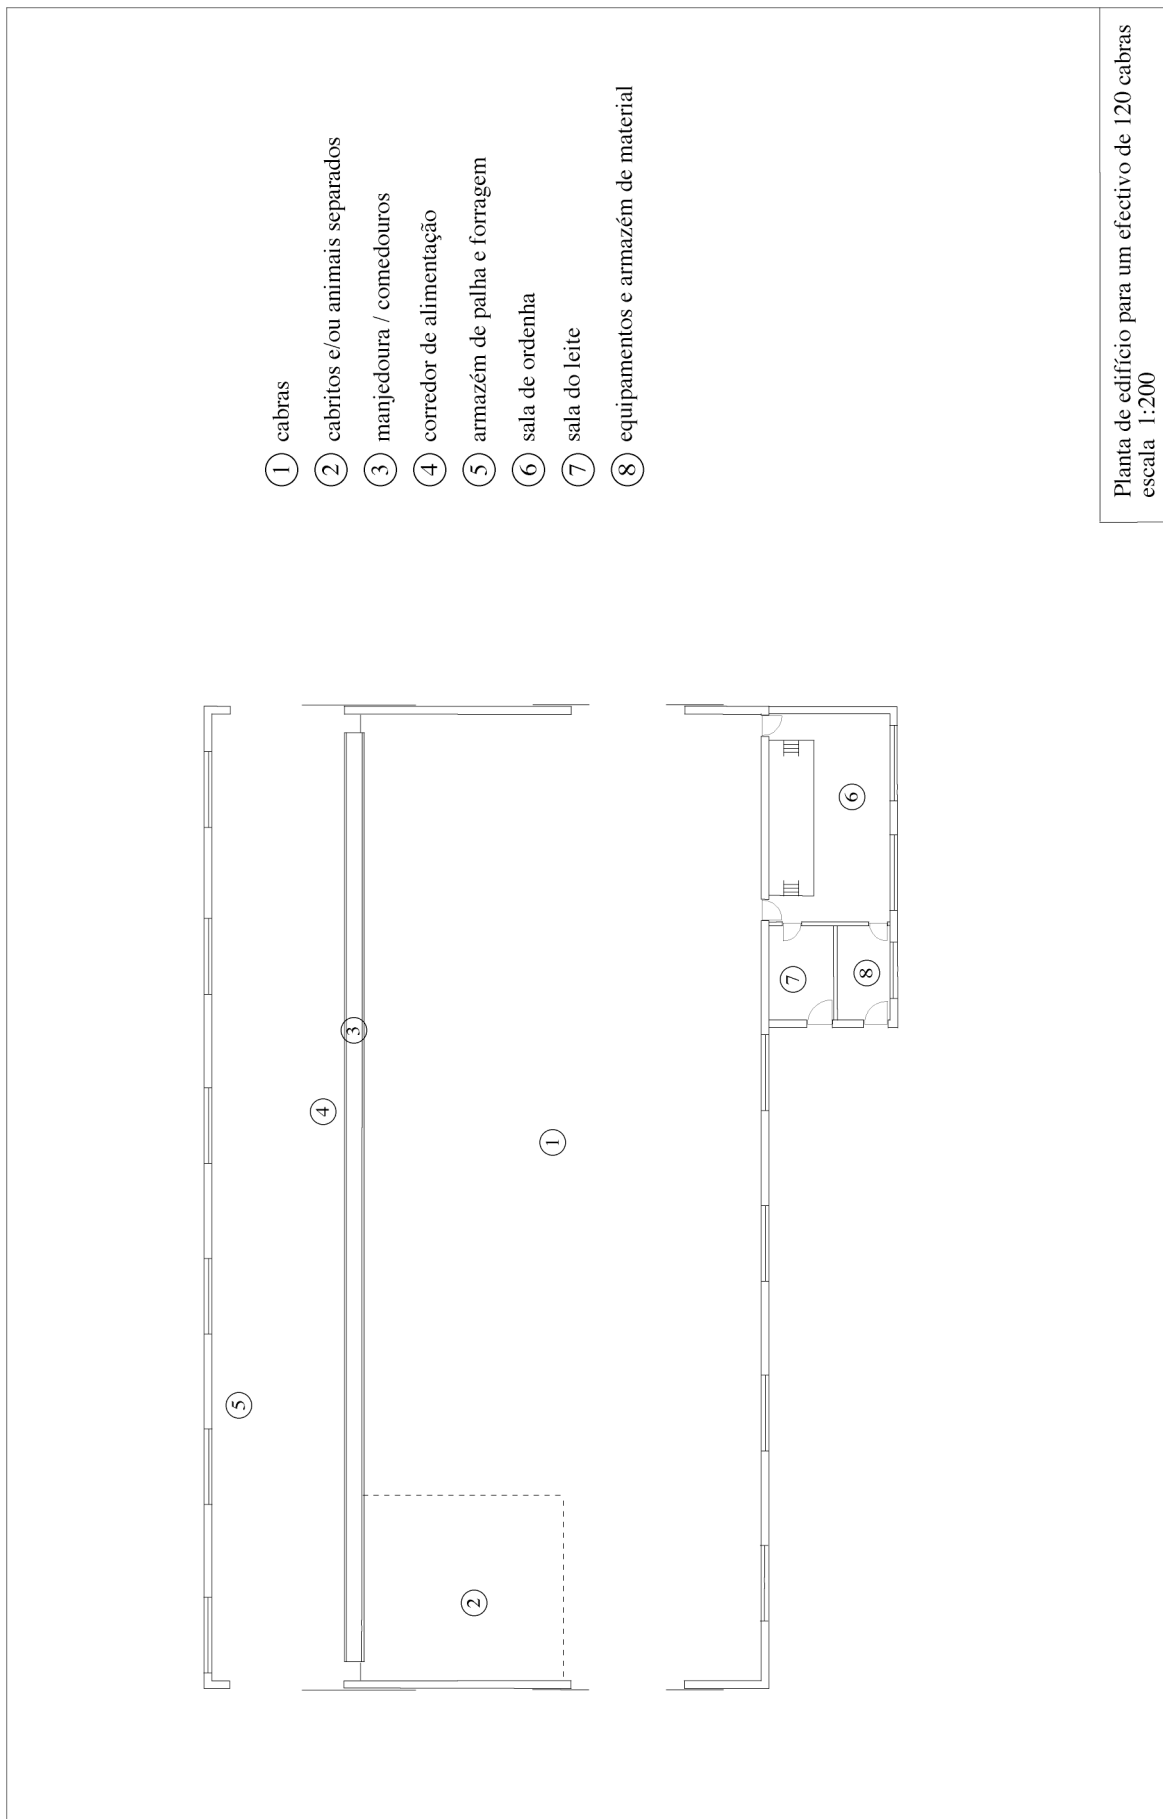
Planta de edifício para alojamento de um efectivo de 120 cabras adultas.
